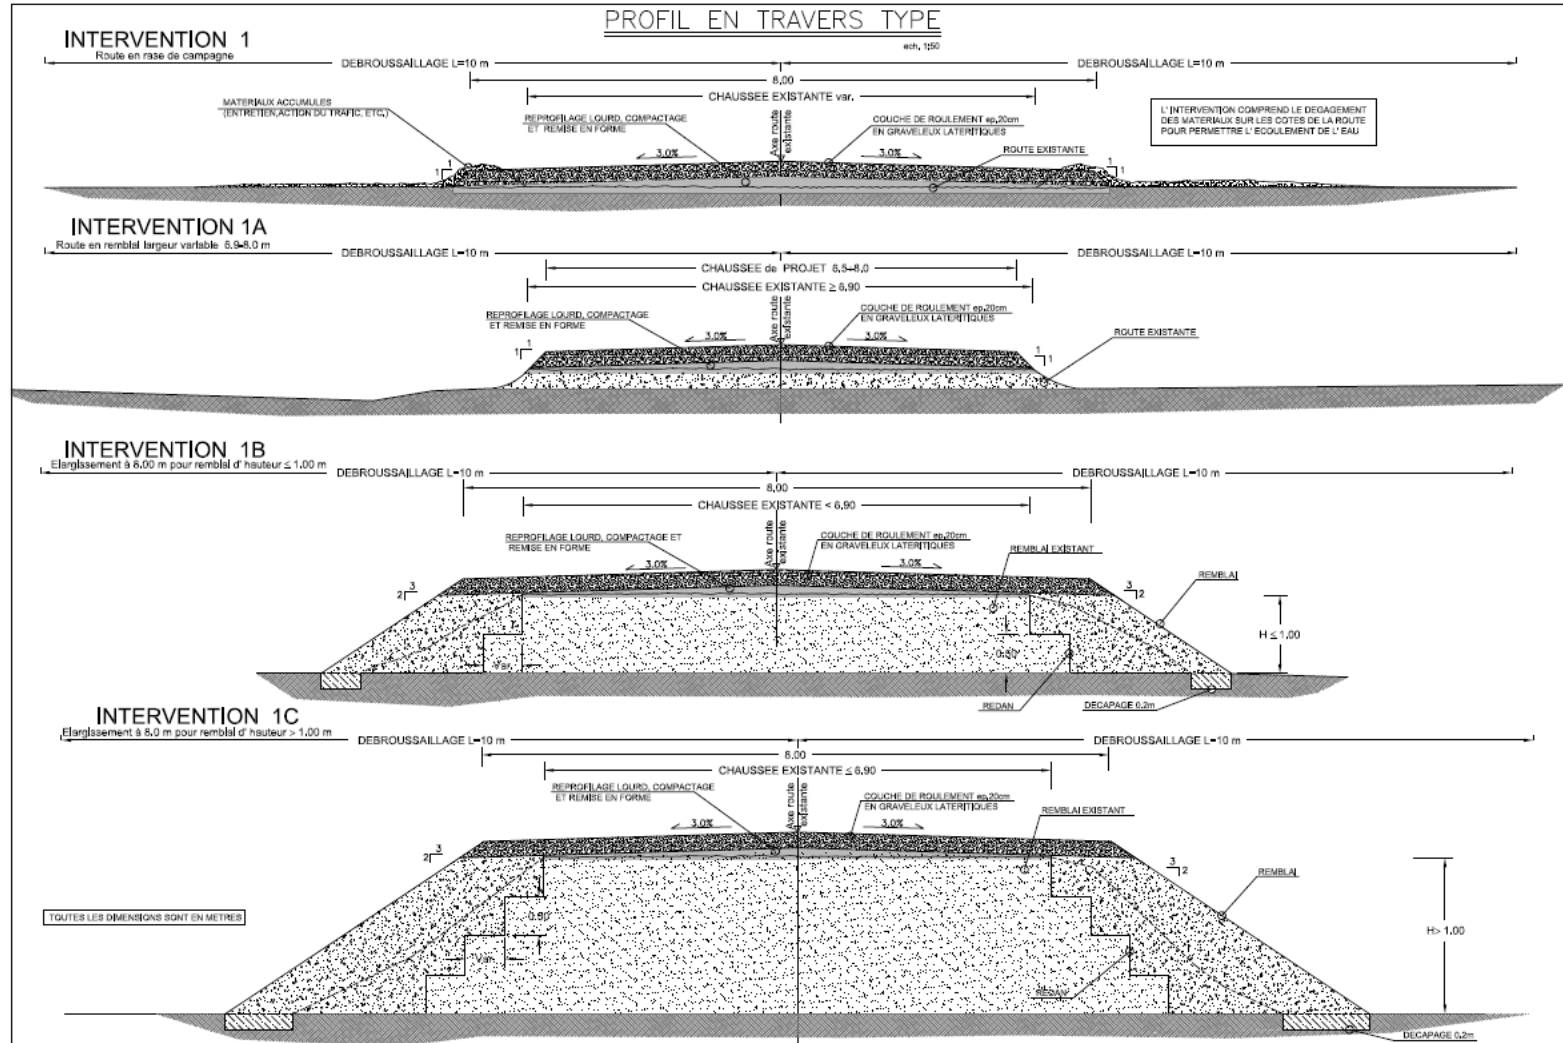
Profil en travers de la RN35 : interventions de type 1
